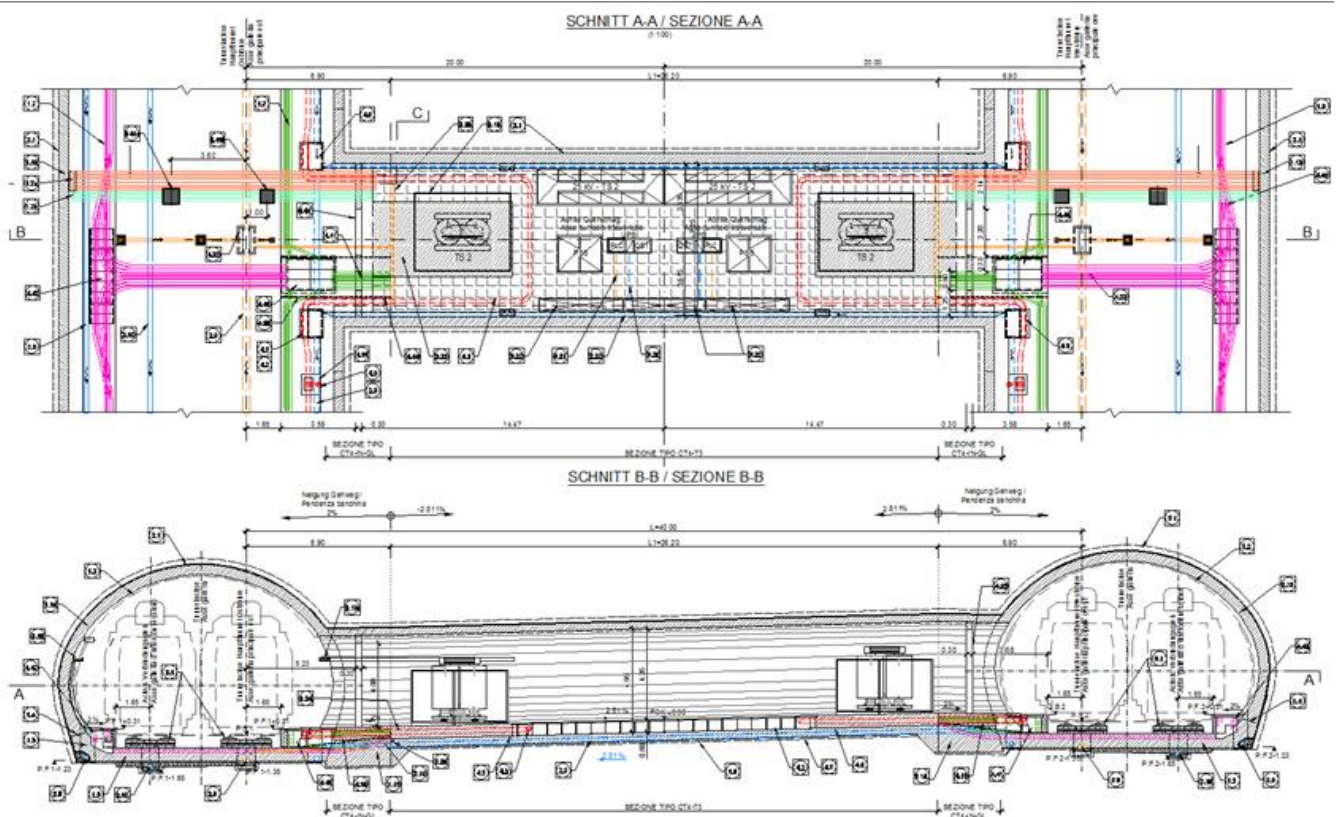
Querstollen Typ 4 - Grundriss und Längsschnitt [96].
